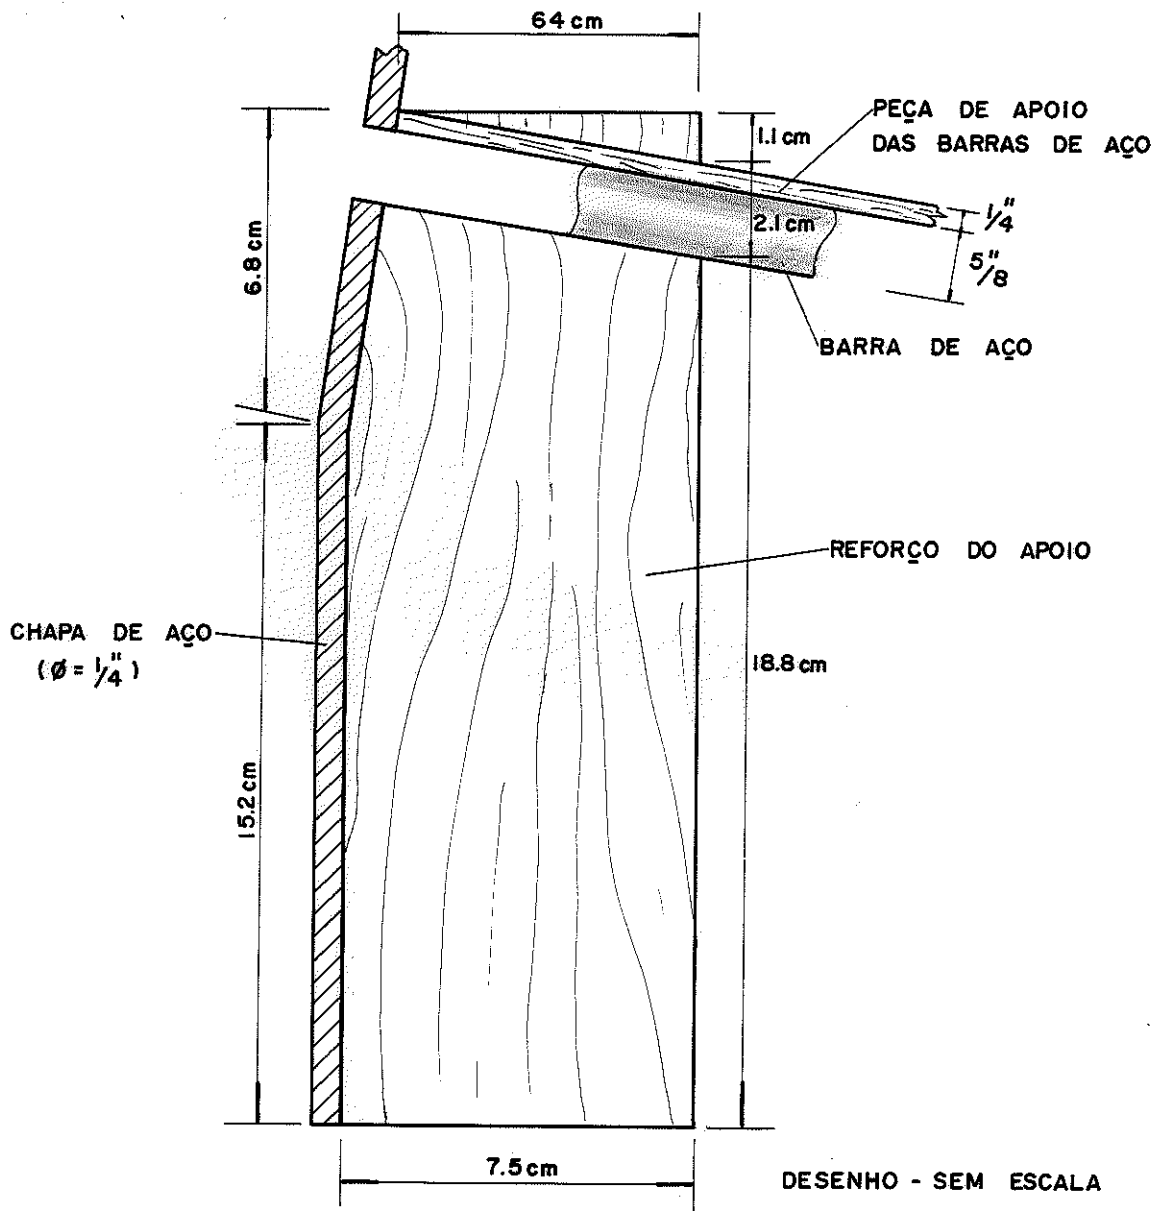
DETALHE DO REFORÇO DO APOIO
